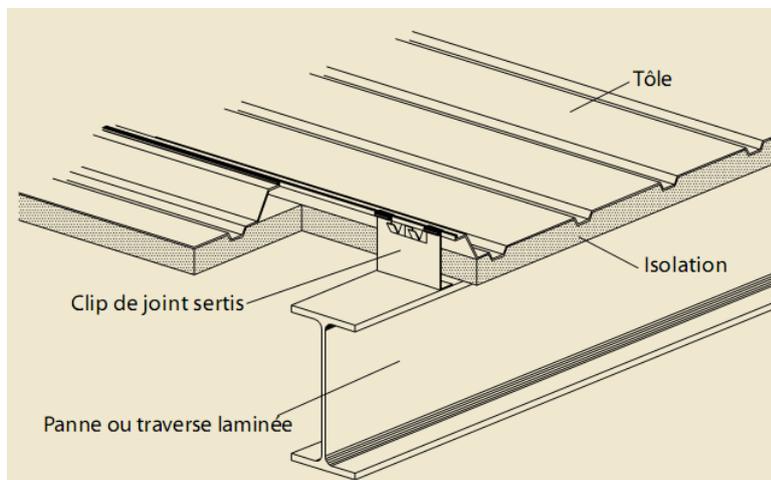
Panneaux à joints sertis avec plateaux de doublage
